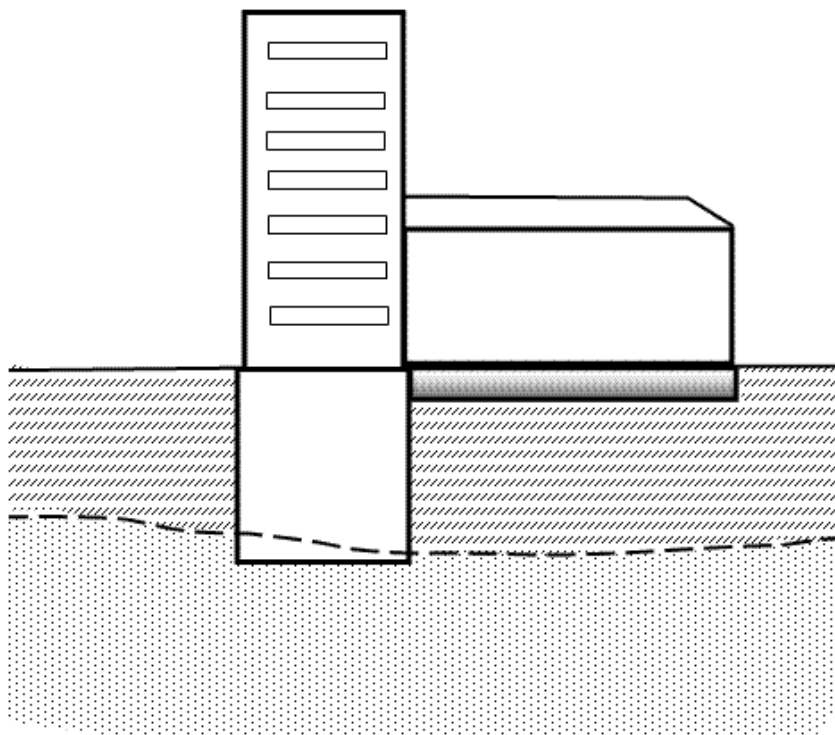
Неравномерные осадки сооружений при опирании фундаментов сооружения на разные грунты [12]
